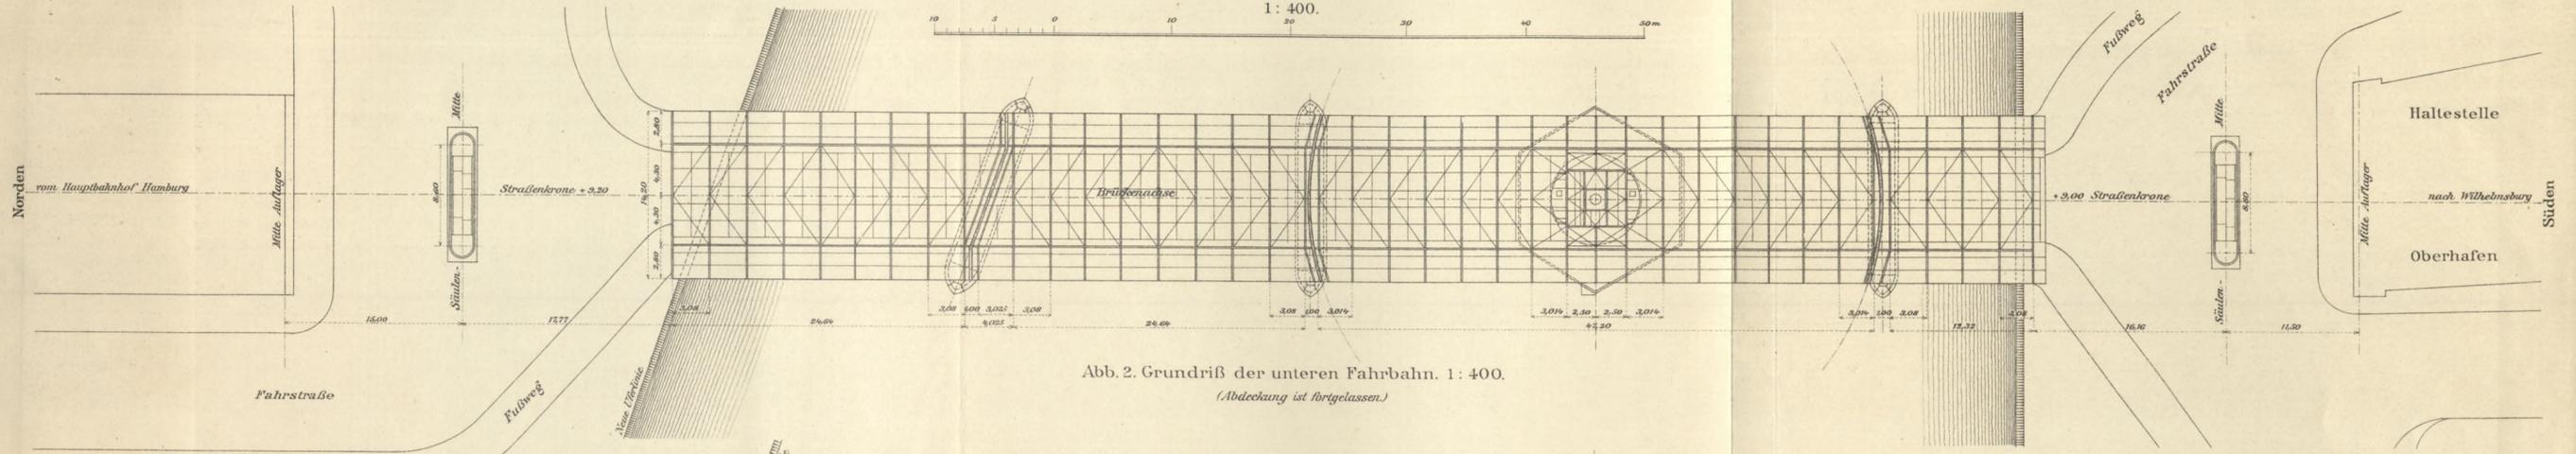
Grundriß der unteren Fahrbahn. 1: 400.
